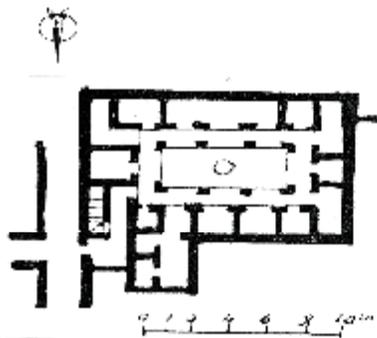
مسقط أفقي لجامع المنصورة المريني بلمسنا.
